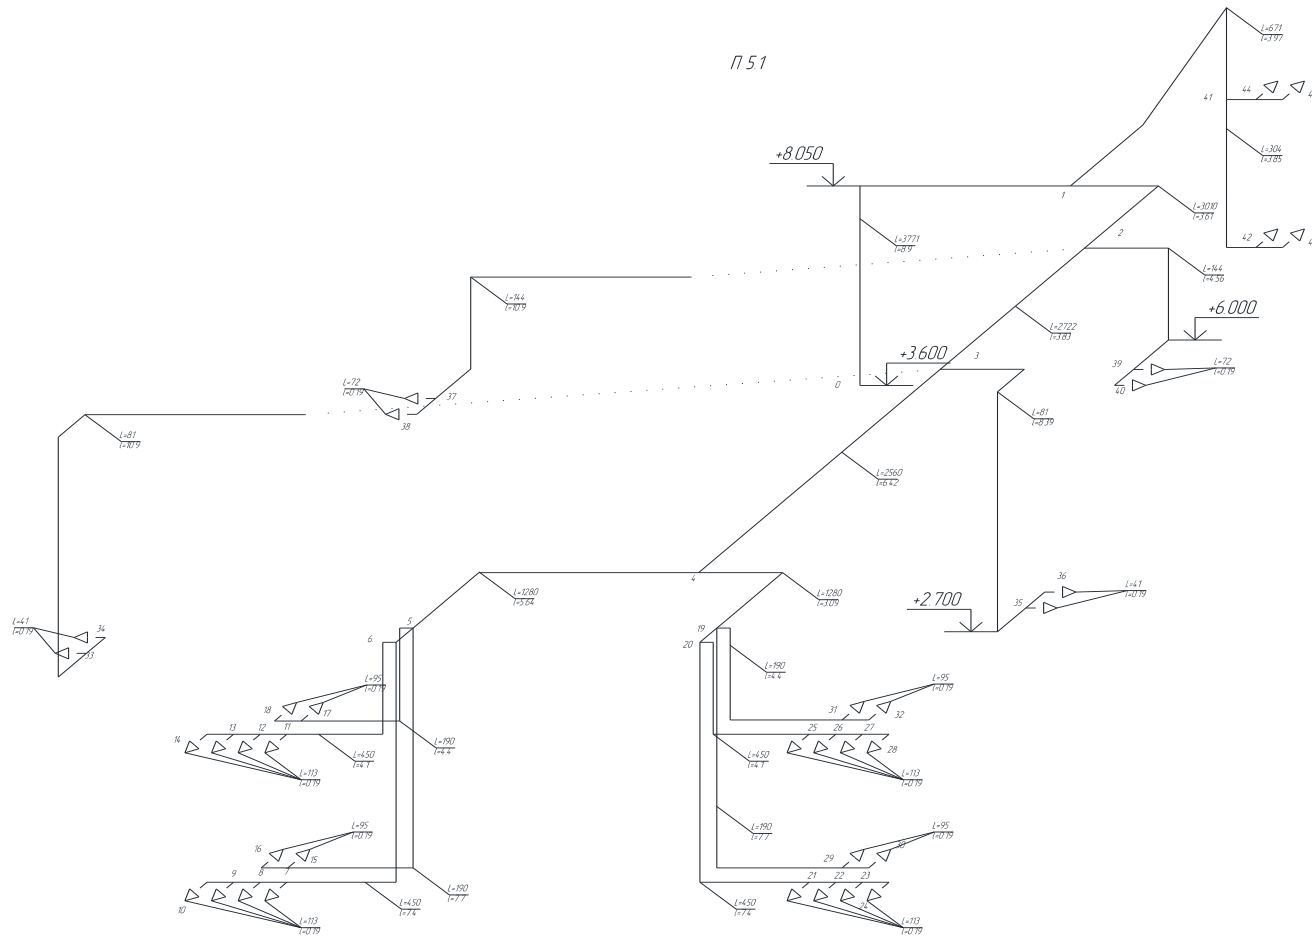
Расчетные схемы систем вентиляции блока №5
